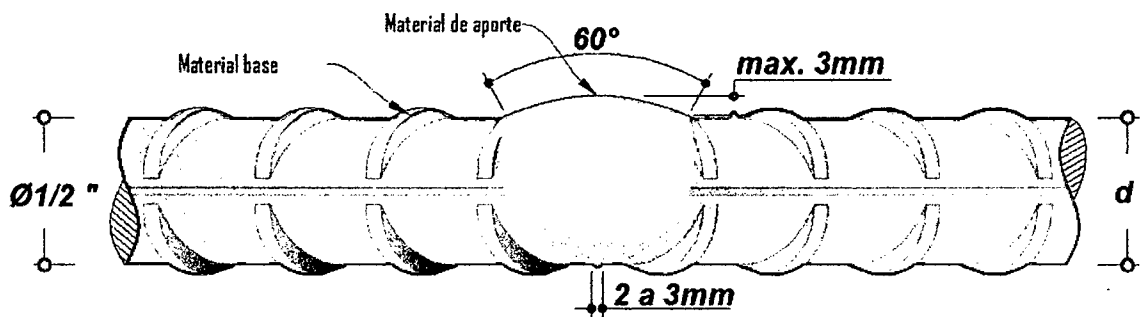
Detalle de terminado de soldadura a tope directo de barra de $\varnothing 1/2''$.
